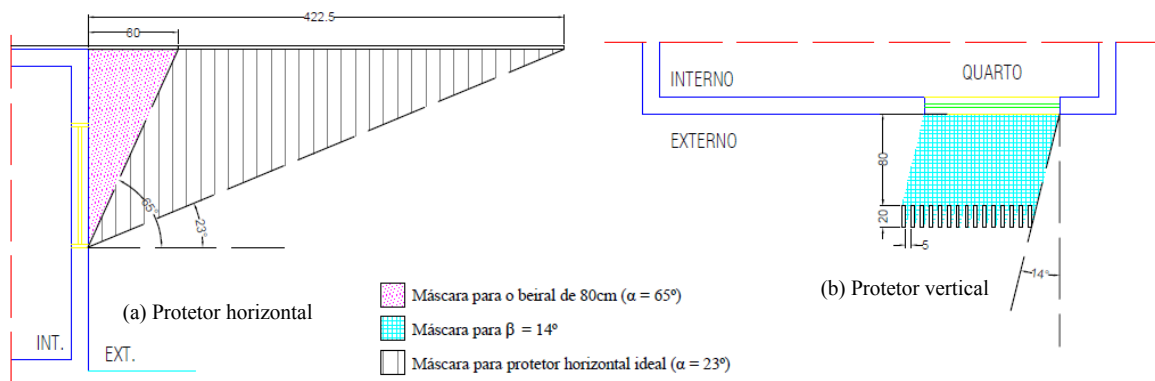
Protetores solares da fachada Nordeste. Fonte: elaborado pela autora
